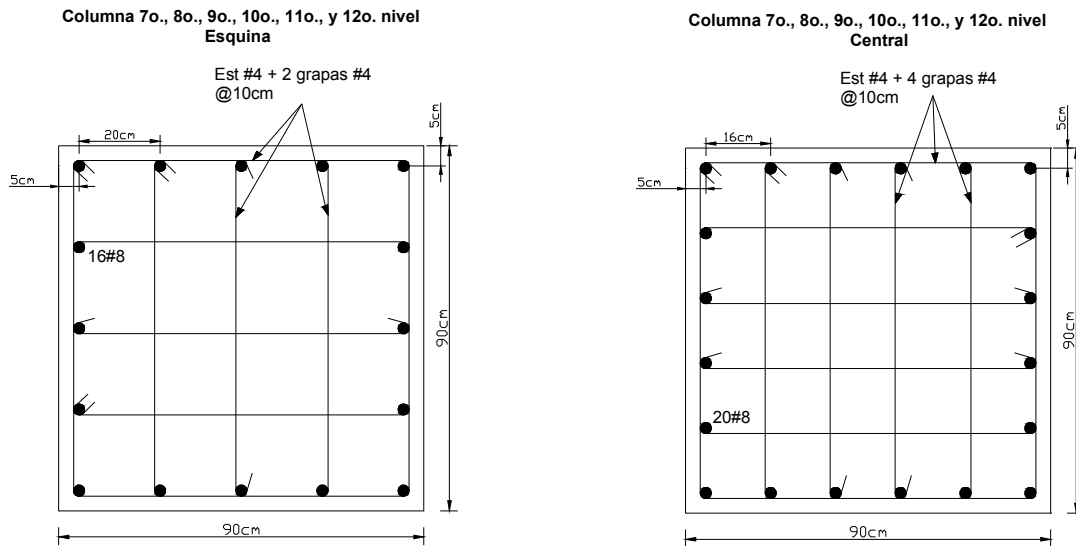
Detallado de estribos en los extremos de las columnas, niveles 7 a 12
